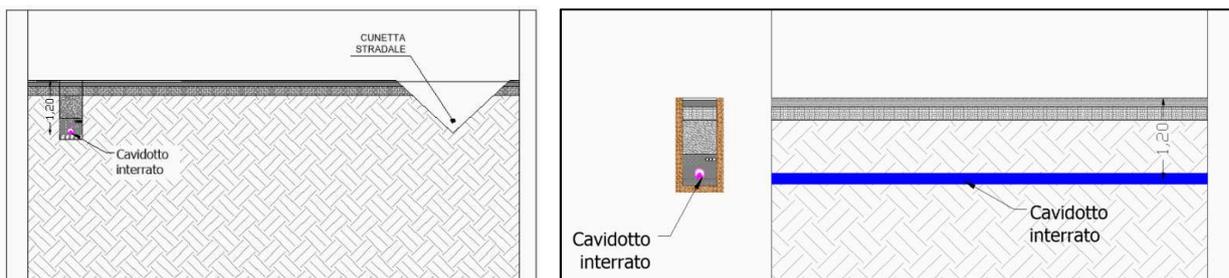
Particolare tipologico attraversamento longitudinale e attraversamento trasversale delle strade (attraversamento strada Contrada Monte Altino)
